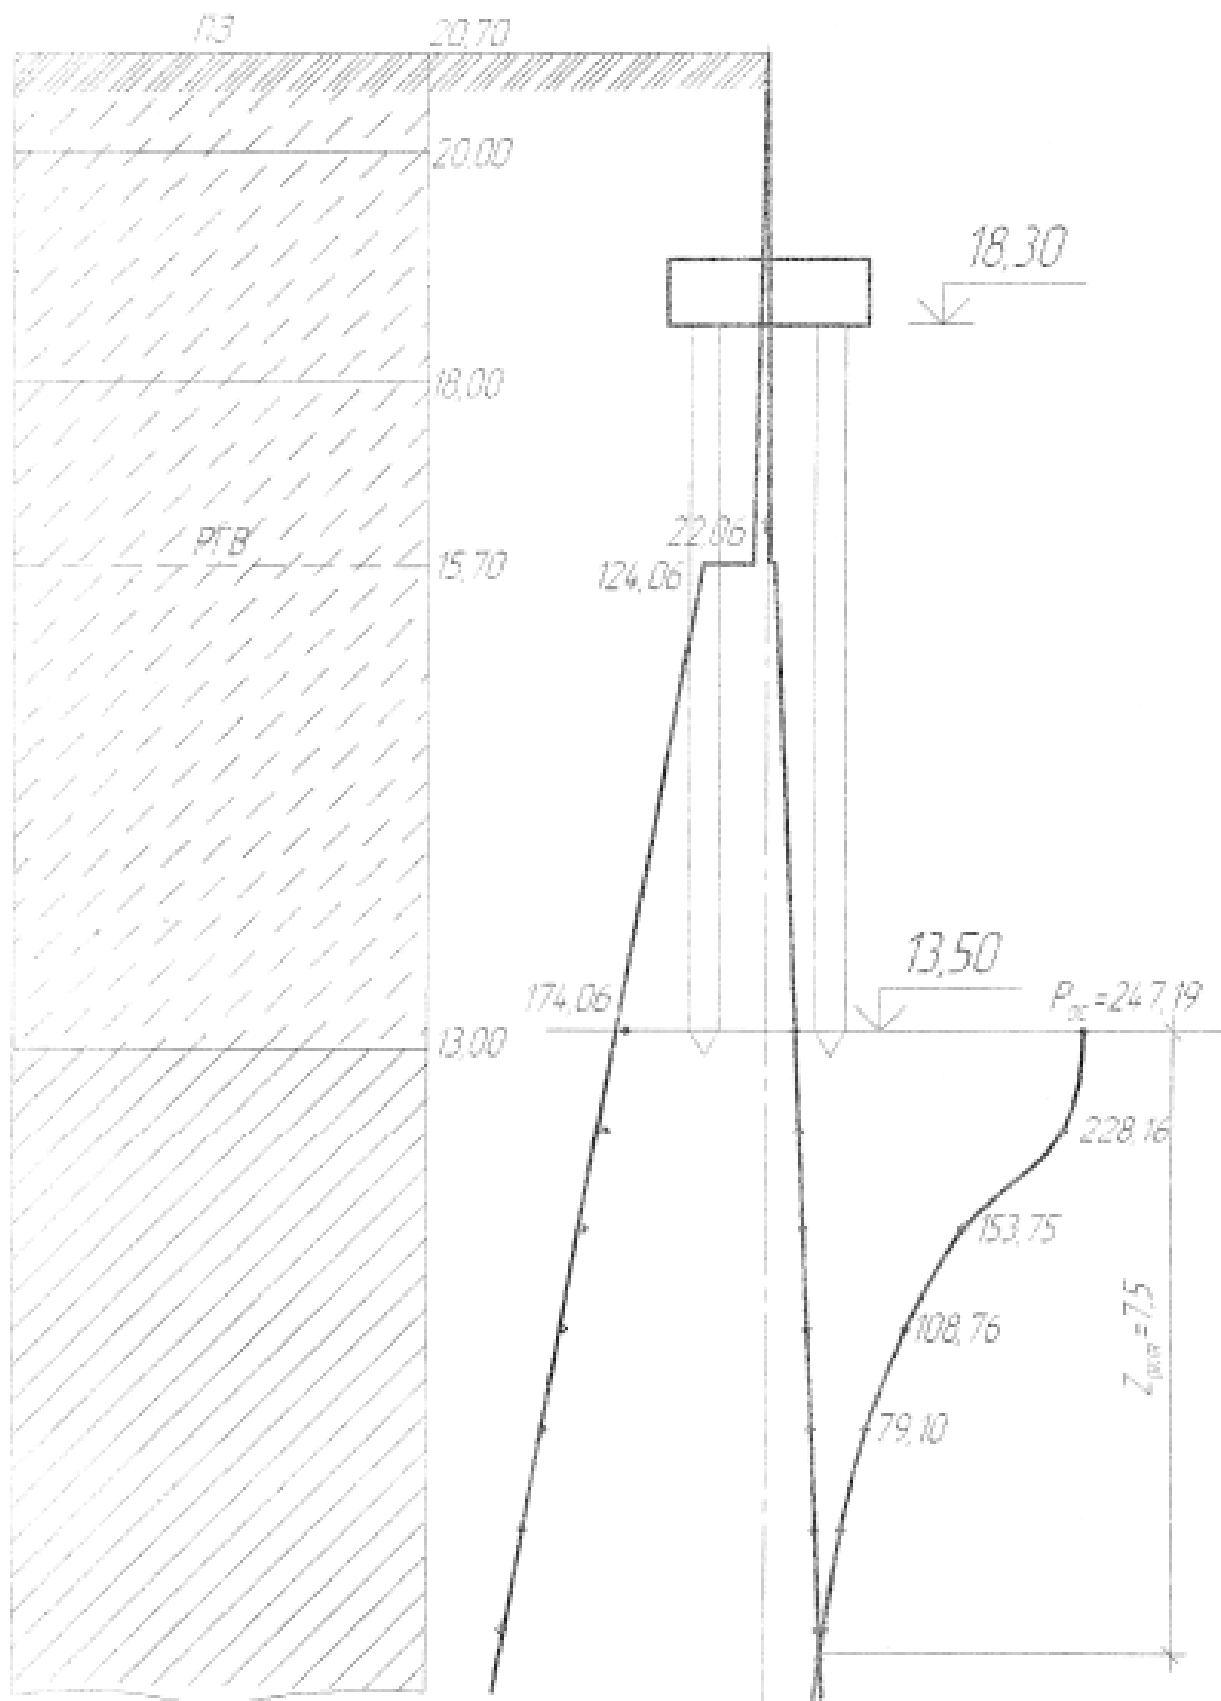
Схема до розрахунку осідання фундаменту методом пошарового підсумування
